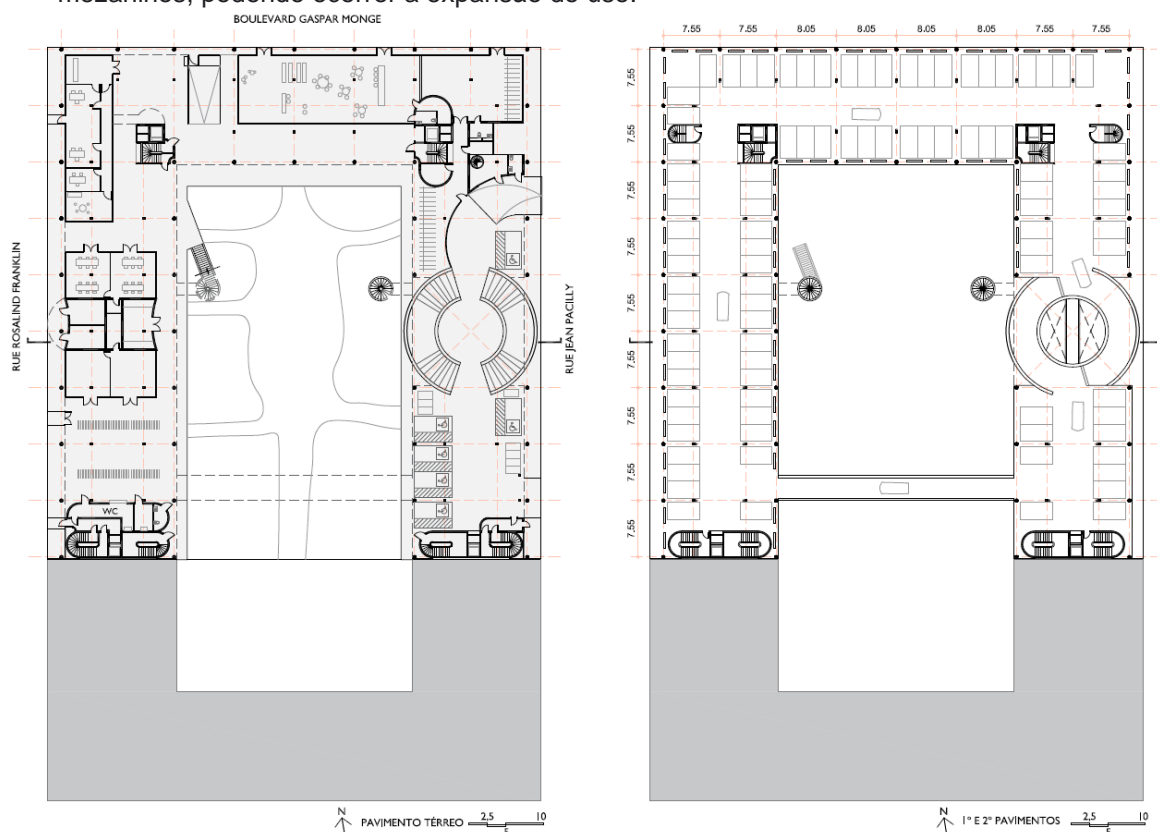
Plantas do pavimento térreo e estacionamentos superiores (1º e 2º pavimentos).
